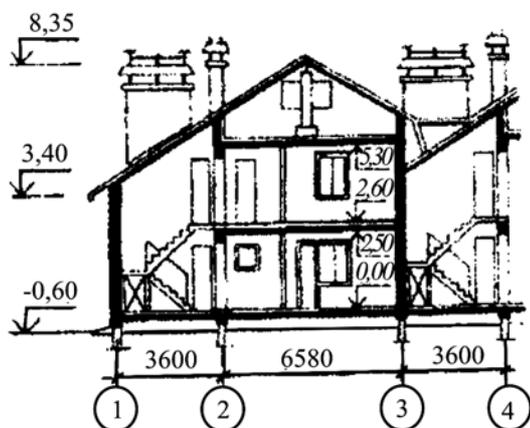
Типовой проект блокированного жилого дома с внутренним двориком (серия 206):
